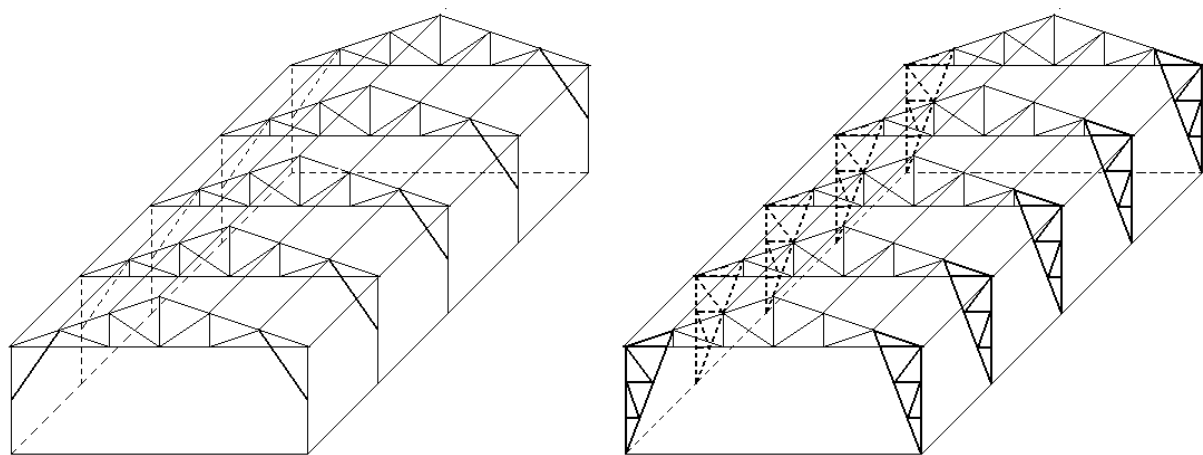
Contraventamento no plano horizontal dos banzos inferiores.
